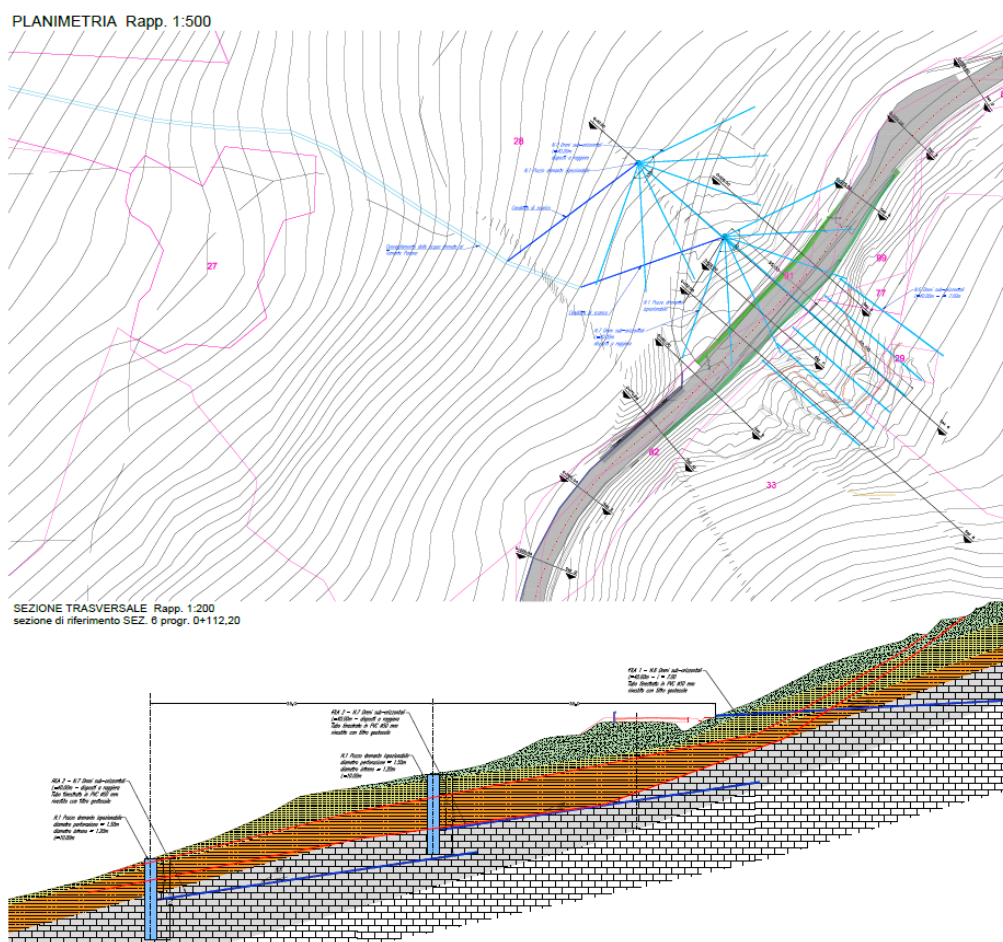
Planimetria e sezione della progettazione "intervento ipotesi 3"
